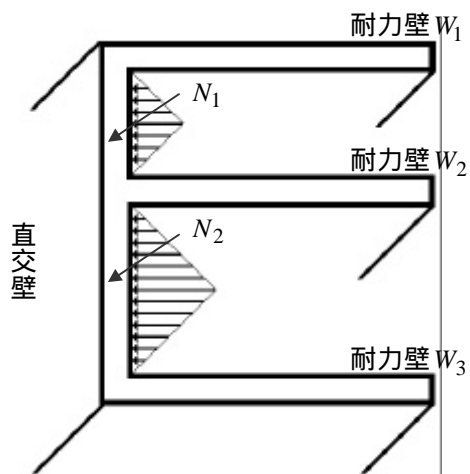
壁梁のせん断力の拘束による耐力壁水平抵抗力への寄与分
